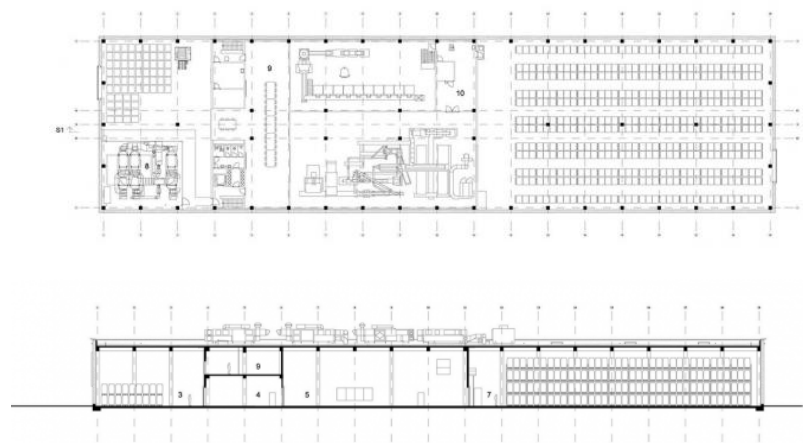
Planta y Sección. Fuente: Herzog & de Meuron
